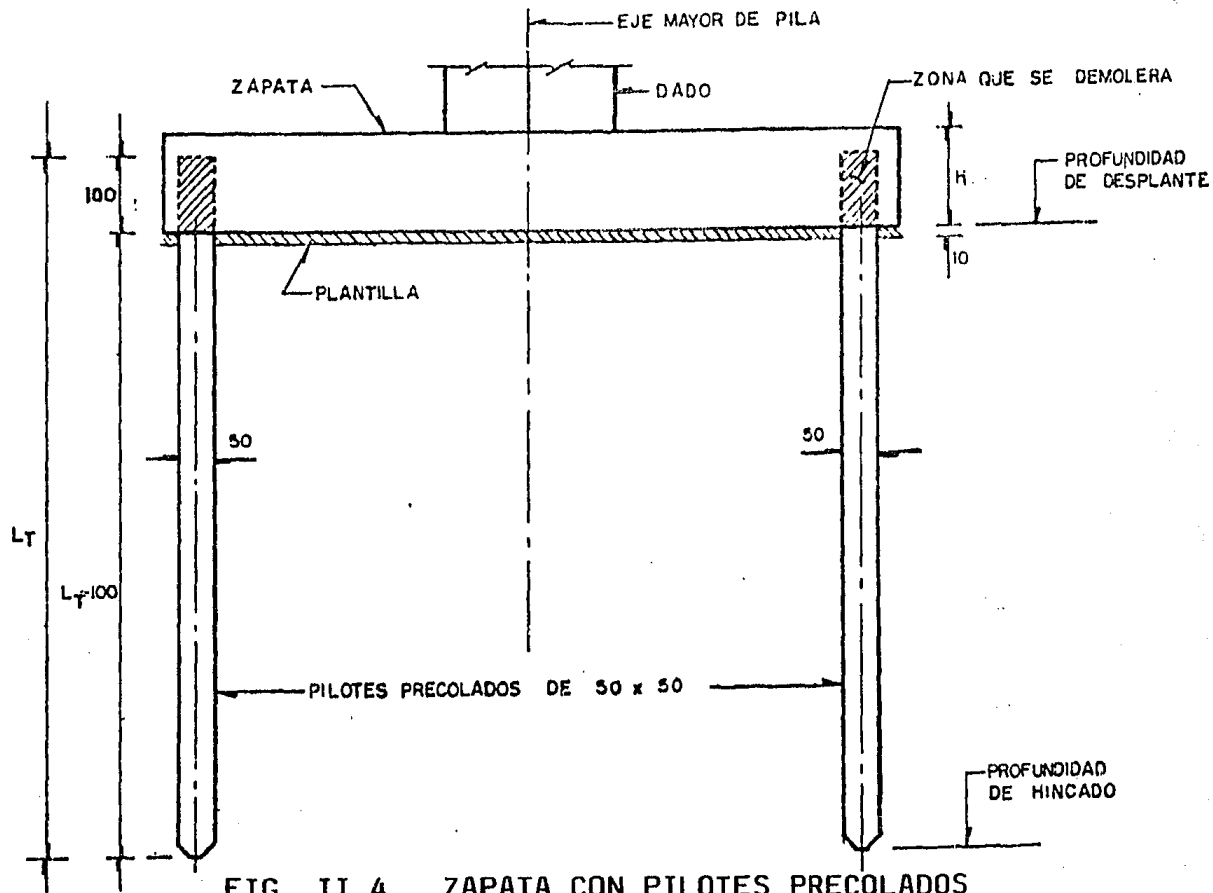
ZAPATA CON PILOTES PRECOLADOS
